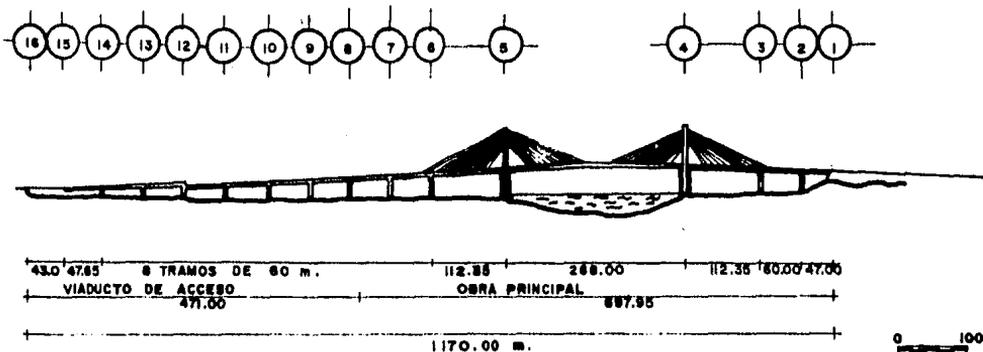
PERFIL LONGITUDINAL DEL PUENTE COATZACOALCOS II .
